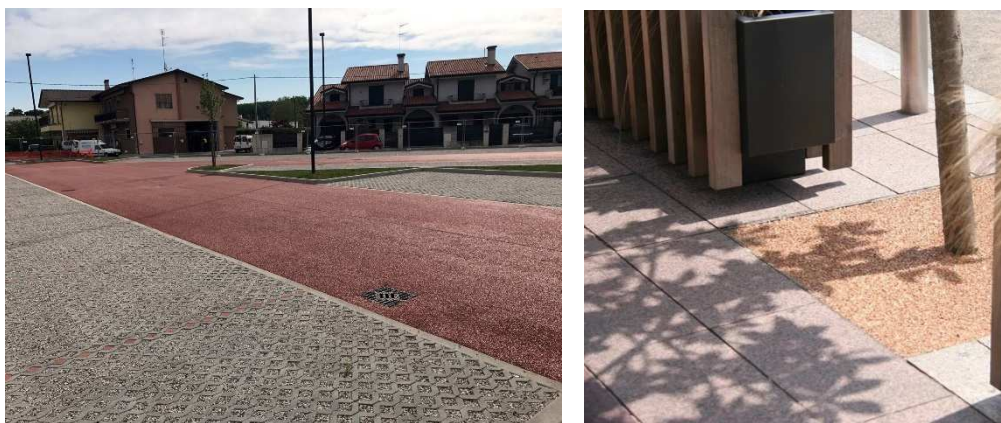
Pavimentazione drenante in corrispondenza di camminamenti e alberature con ghiaio attorno a colletto
